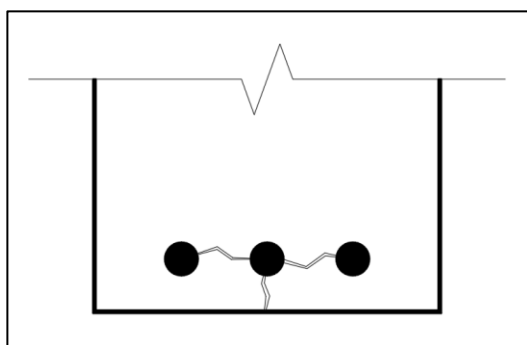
Fissuras por fendilhamento. (Fonte: autor)
